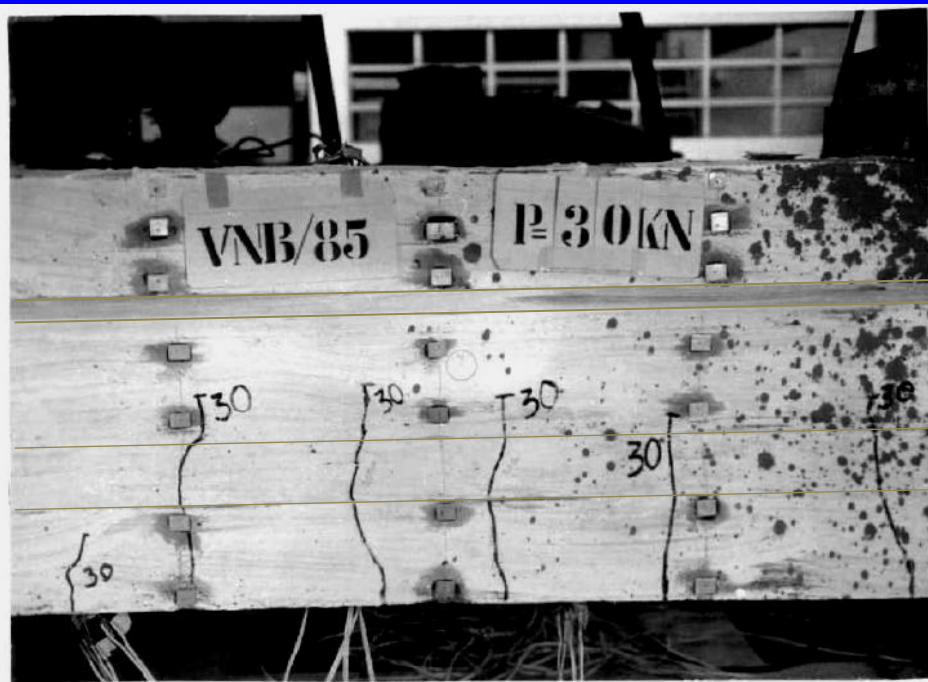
Primeiras fissuras da viga VNB/85
